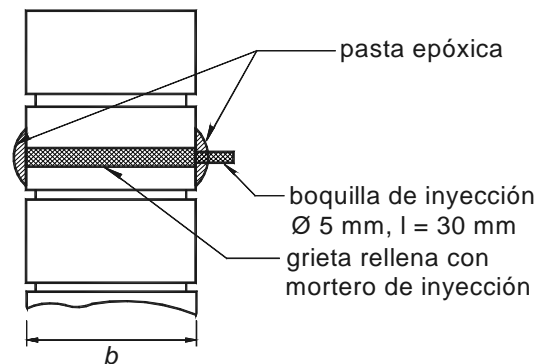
Reparación de grietas en estructuras de mampostería mediante inyección
